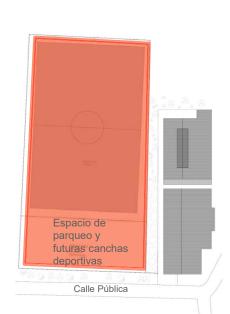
Ubicación en Plano de Conjunto. Elaboración propia.
